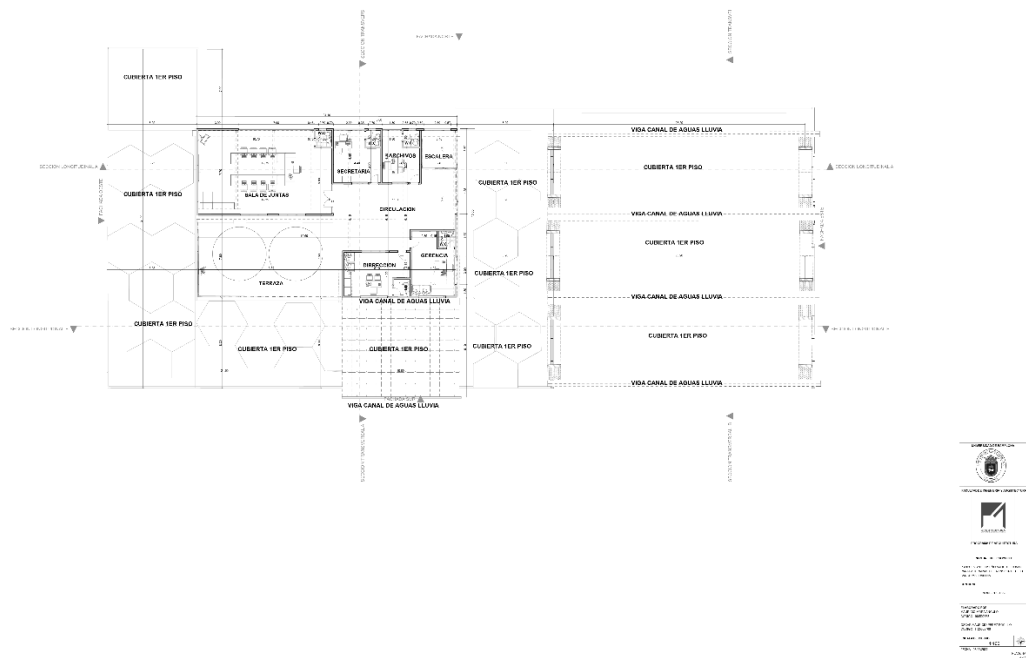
Plano segundo piso, Fuente: elaboración propia.
